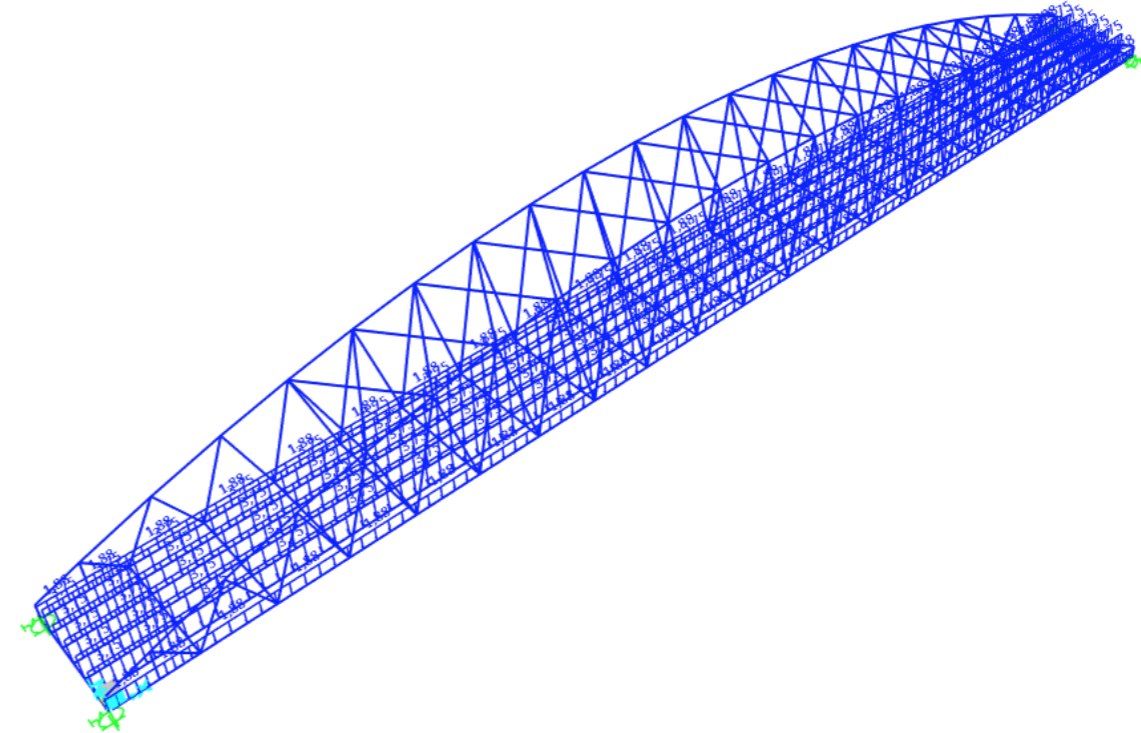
Acción Sobrecarga de uso sobre perfiles longitudinales.
